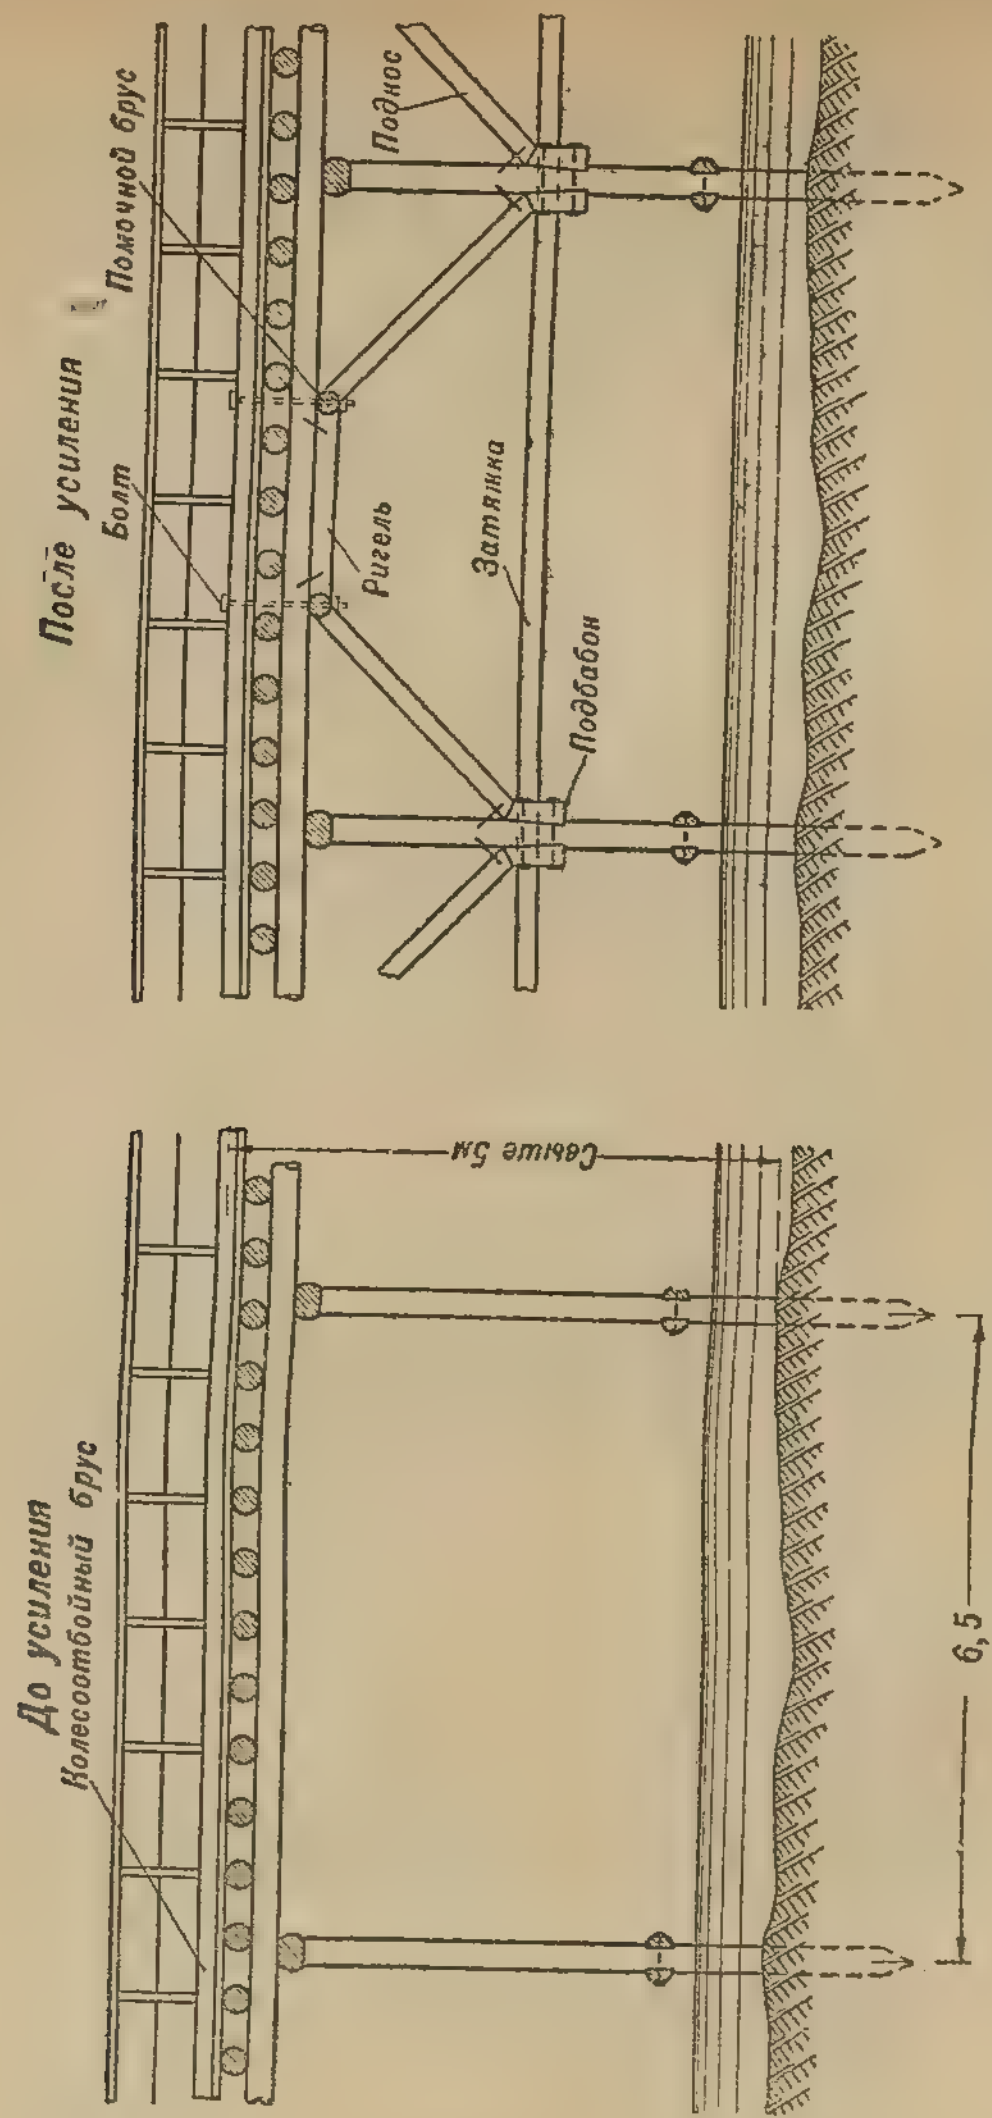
Усиление балочно-о моста подведением ригельно-подкосной фермы;
